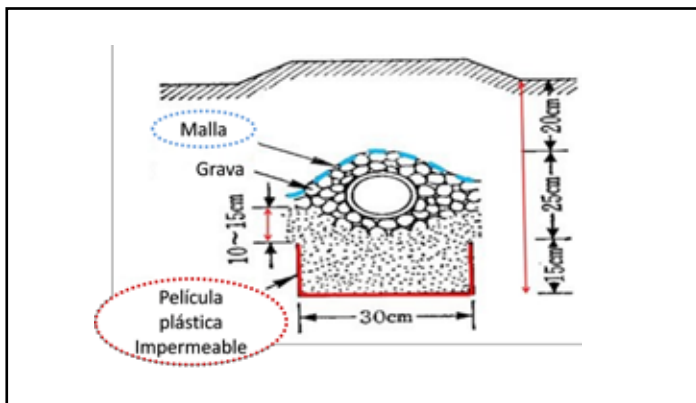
Corte transversal de una zanja de infiltración capilar
